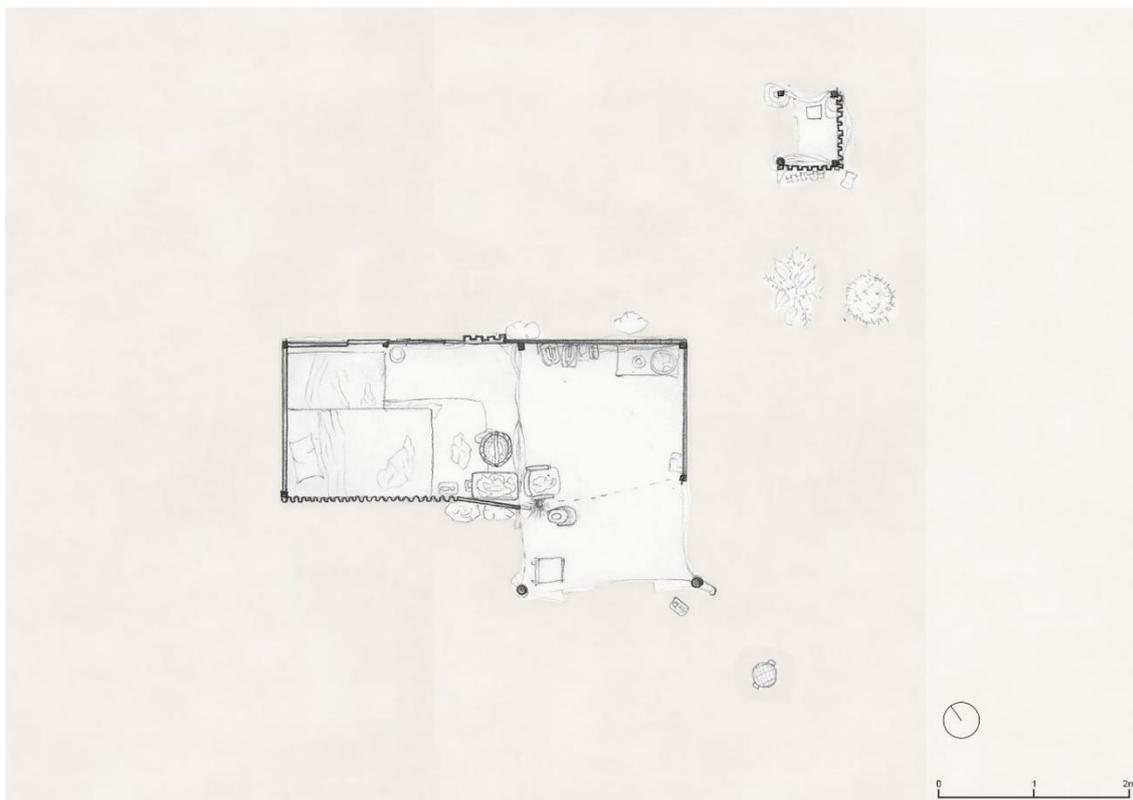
Planta da Casa 5, em 2020. Levantada e desenhada pela autora.
